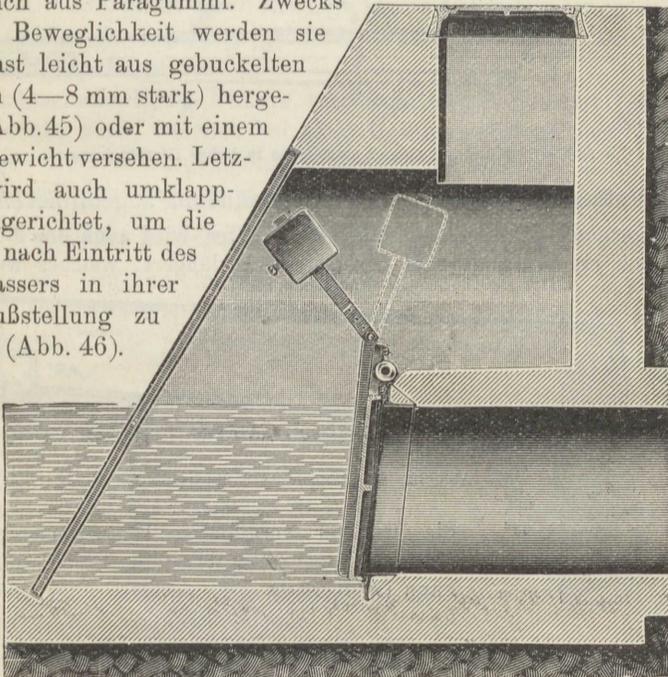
Hochwasserabschlußklappe mit umklappbarem Gegengewicht.
